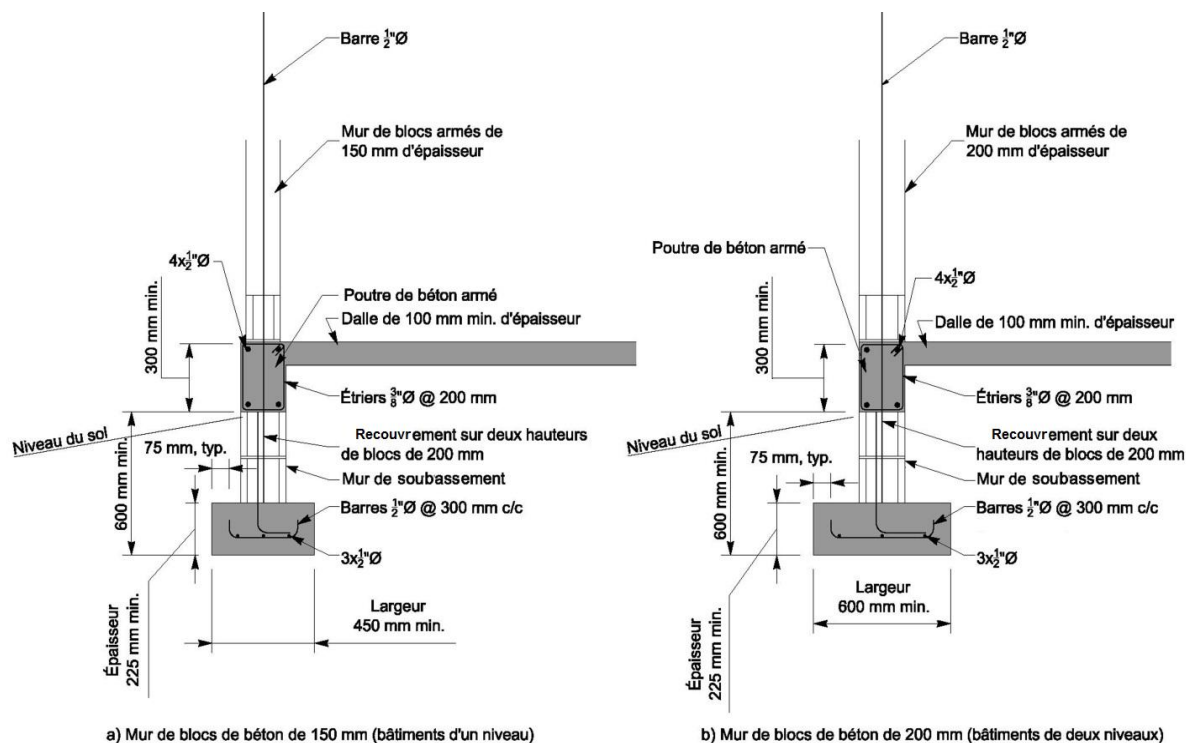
Semelles filantes pour les murs de maçonnerie armée
